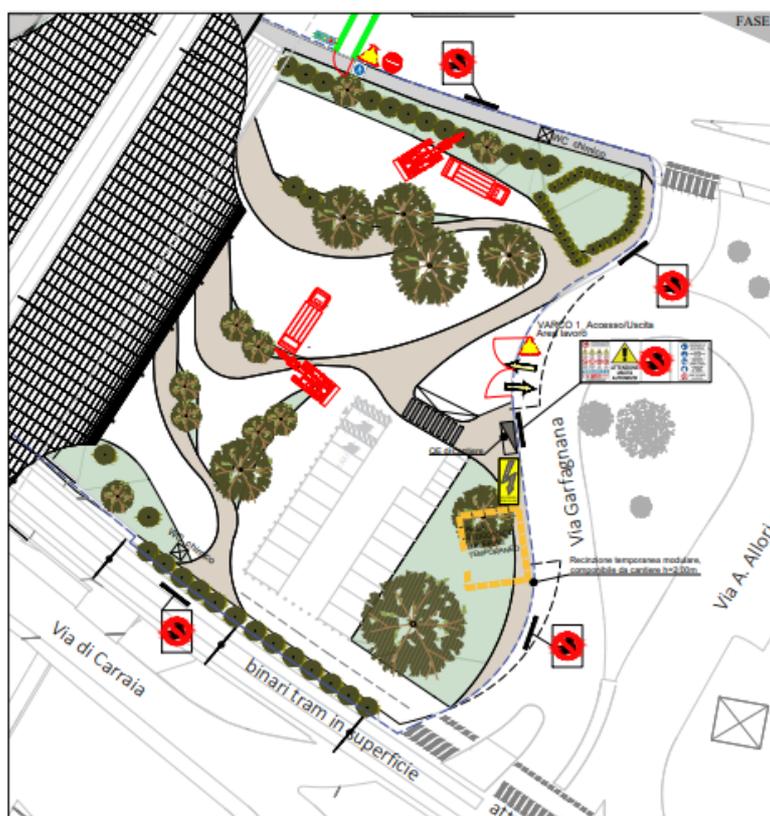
Interventi su aree esterne (Area Sud-Est)
